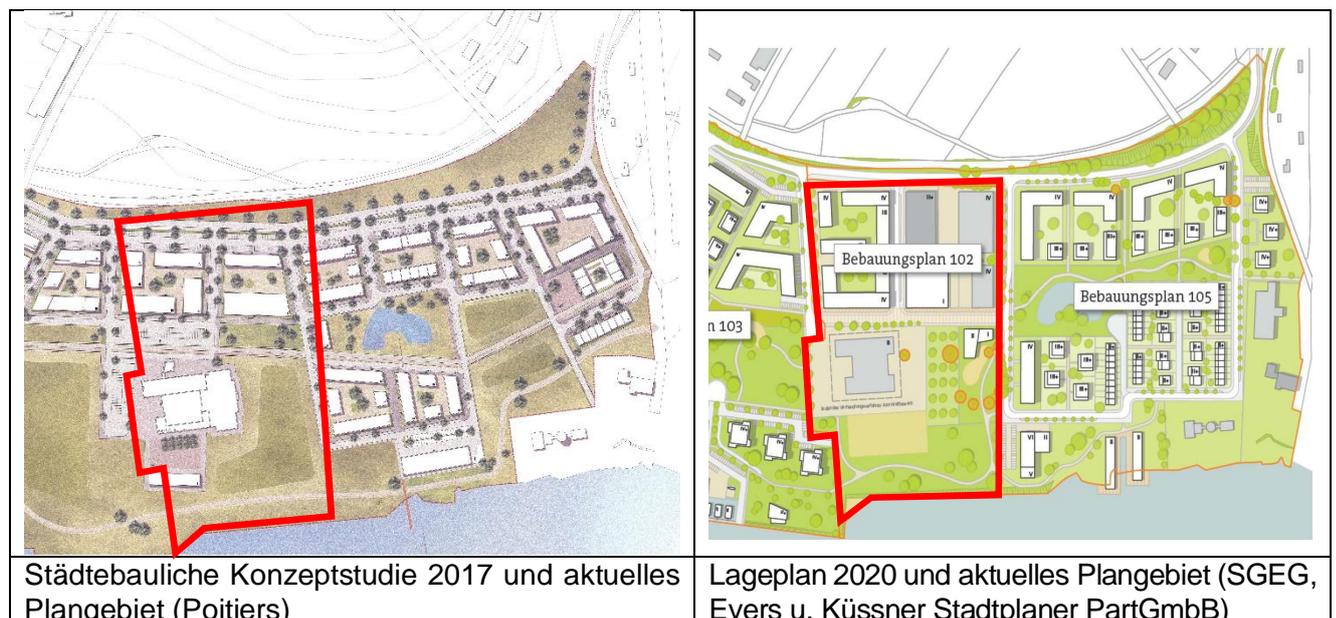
Planungsvarianten Konzeptstudie 2017 und Lageplan Aufstellungsbeschluss 2020
